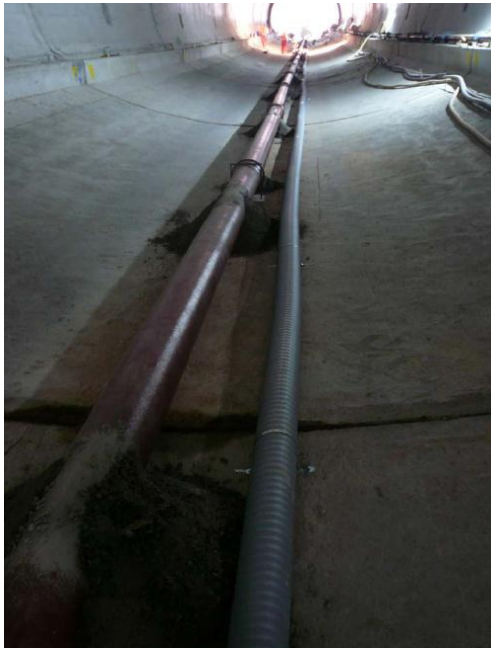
Hauptleitung in der Tunnelsohle, Stadtbahn Stuttgart [2]
